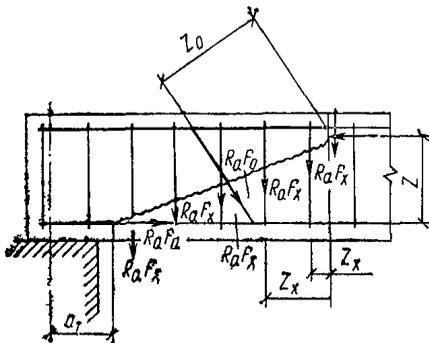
Схема усилий в сечении, наклонном к продольной оси железобетонного элемента, при расчете по прочности на действие изгибающего момента
